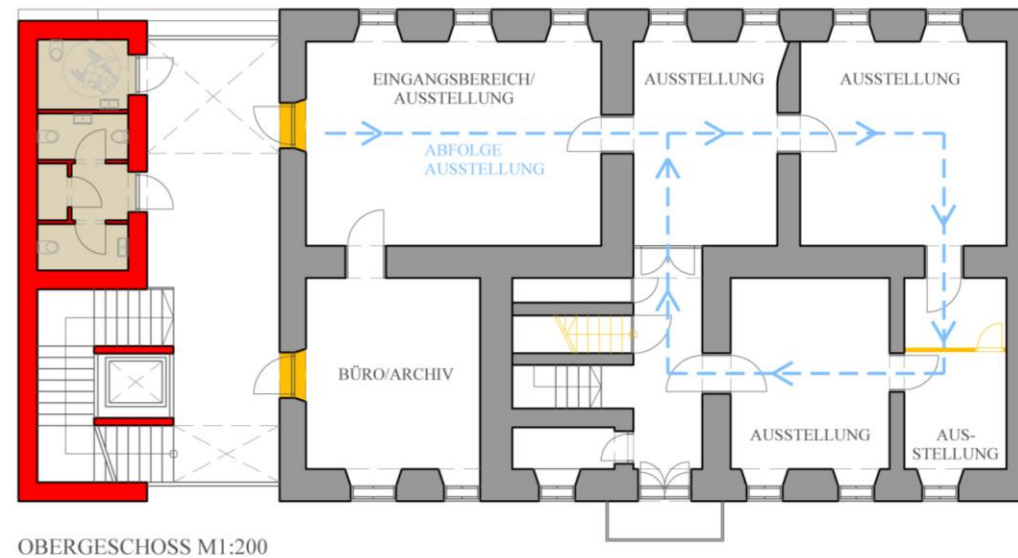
Variante: Obergeschoß als Dorfmuseum, Grundriss, Pfarrhaus Winden am See.
